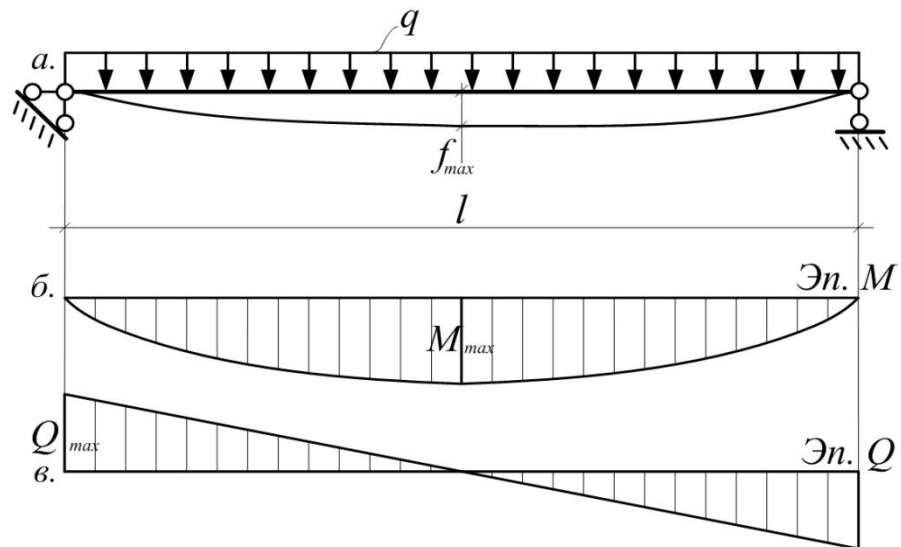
Расчетная схема балки и эпюры внутренних усилий
